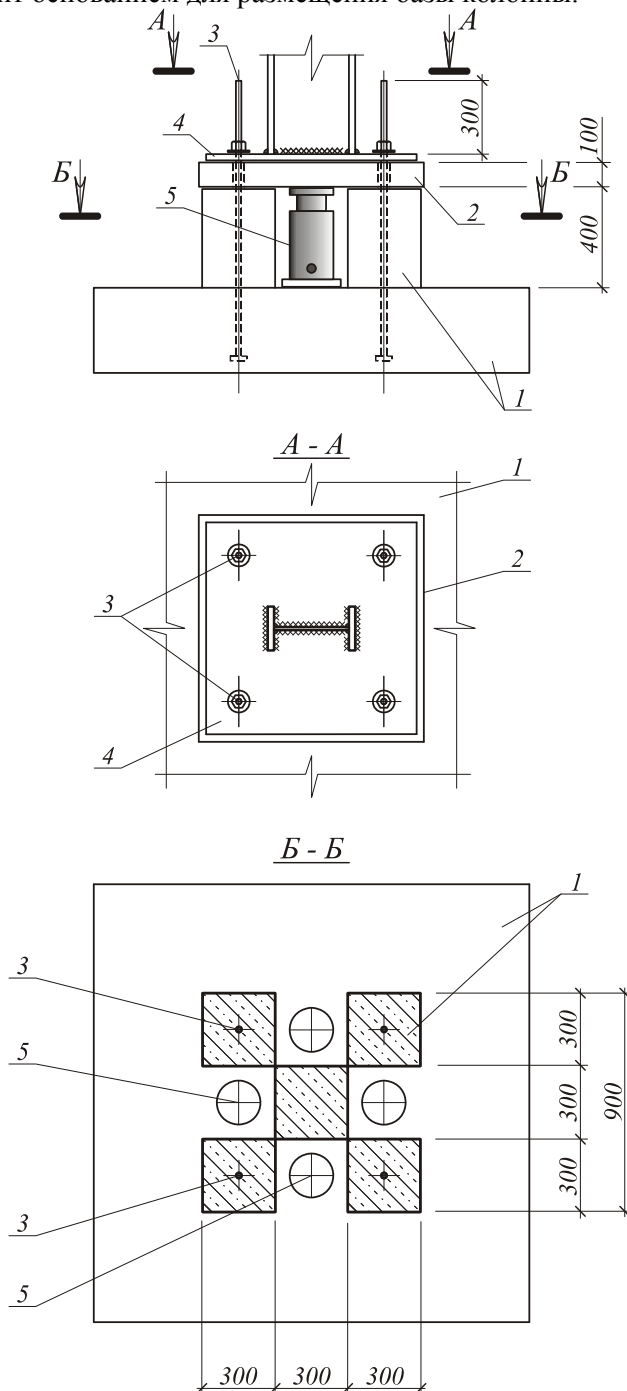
Фундамент колонны с устройством для компенсации чрезмерной осадки
